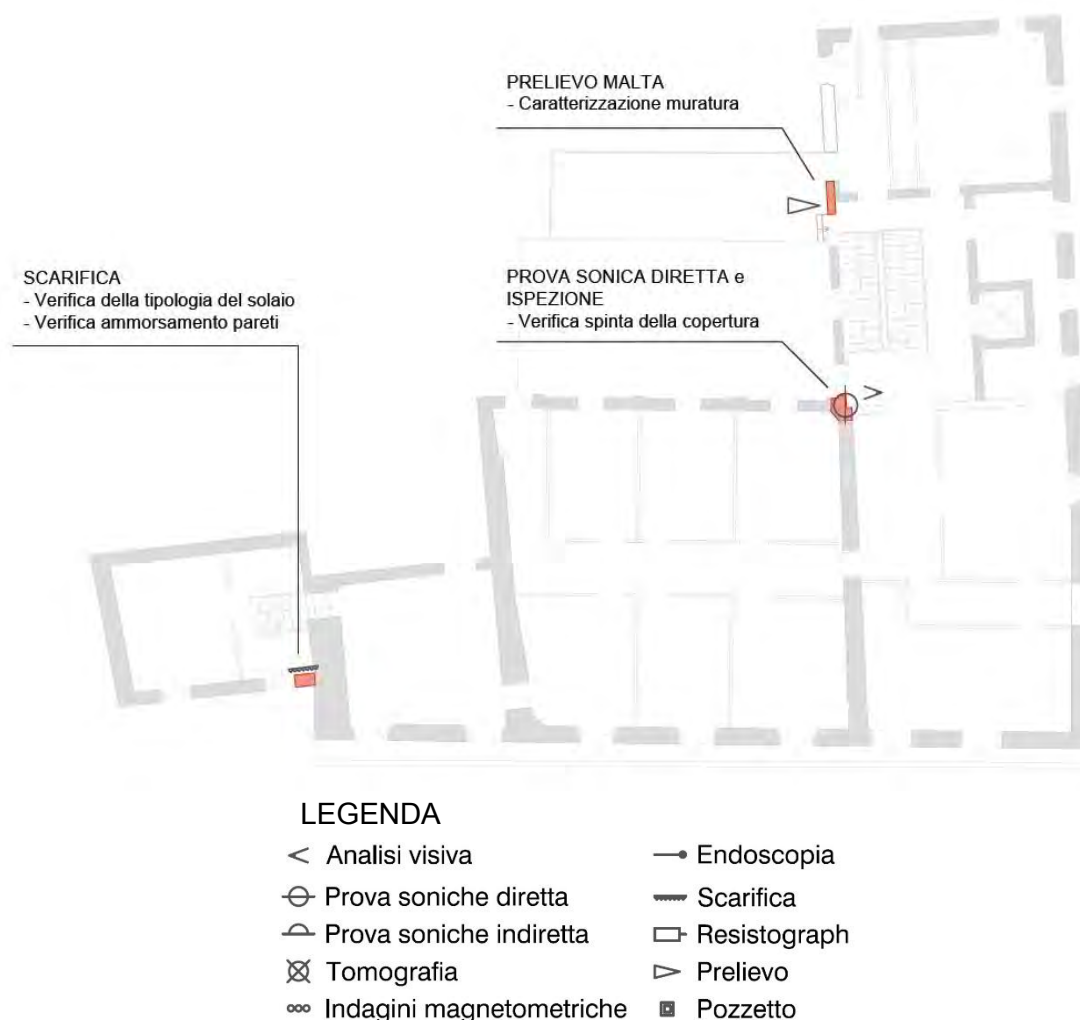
Schematizzazione e legenda della posizione delle prove del piano secondo
